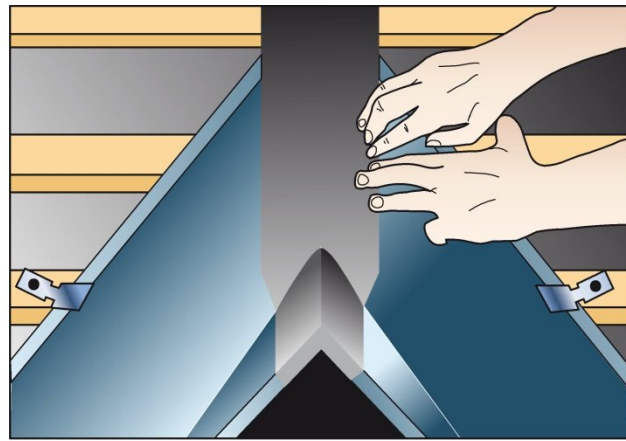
Подготовка ендовы длиной равной скату крыши под укладку черепицы
